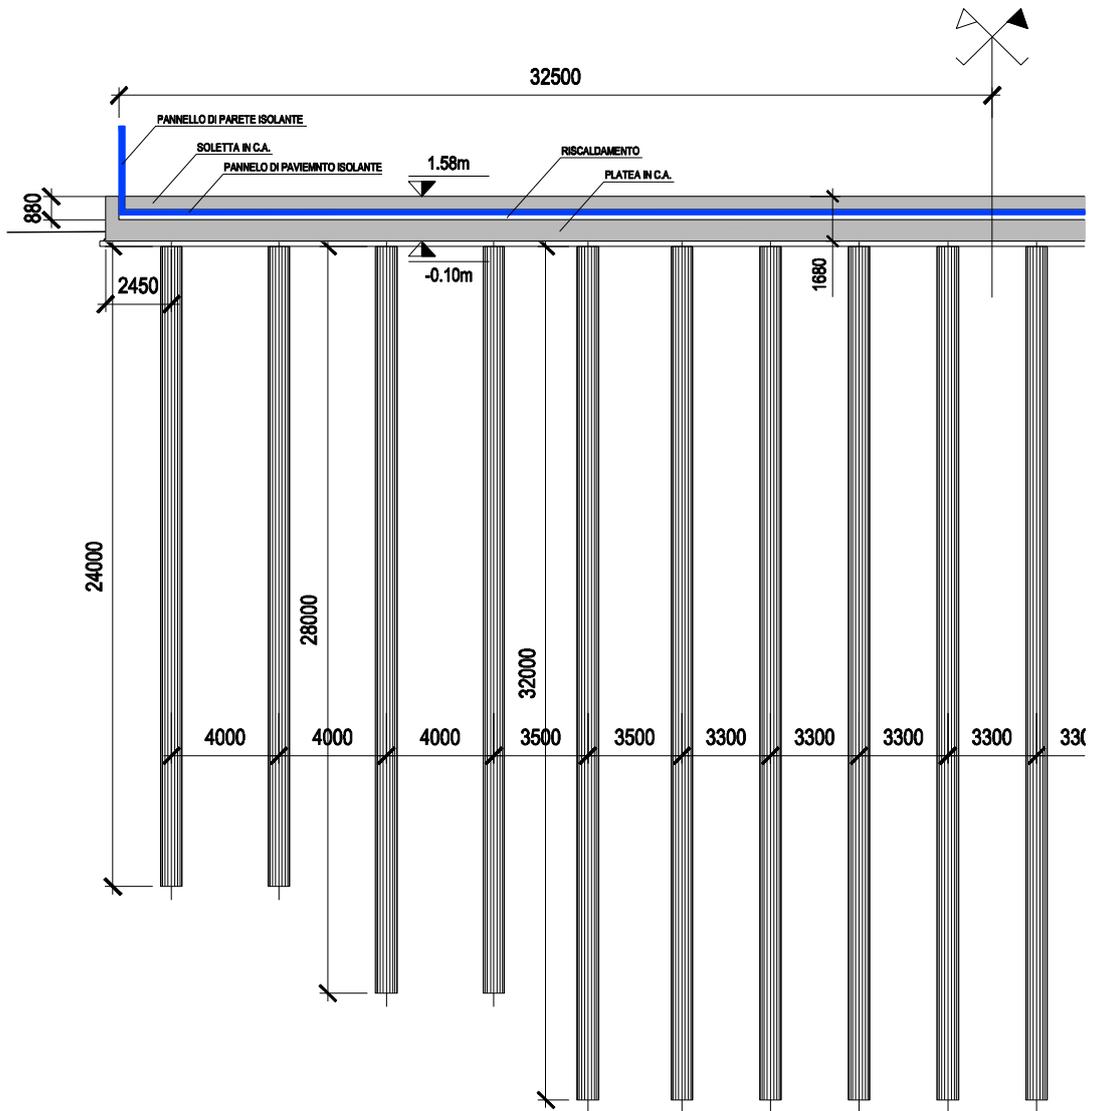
Sezione trasversale tipo fondazioni su pali
